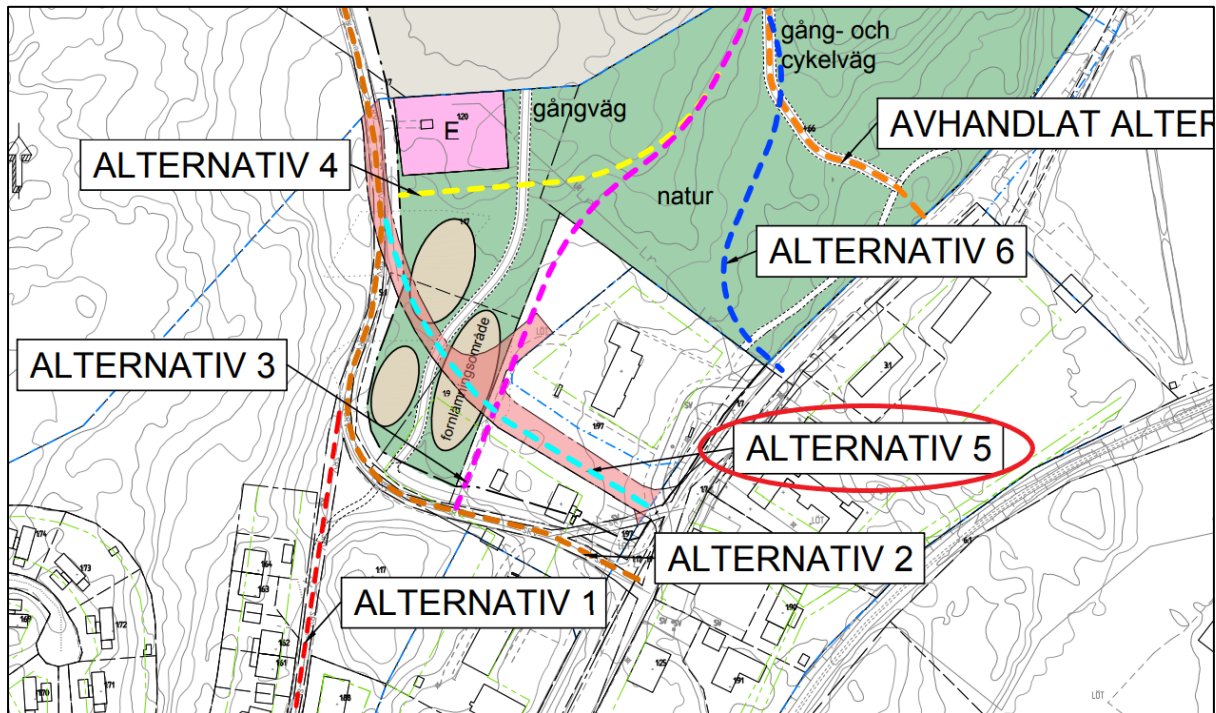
Alternativ 5, angöringsväg enligt gällande plan över Löt 1:97.
